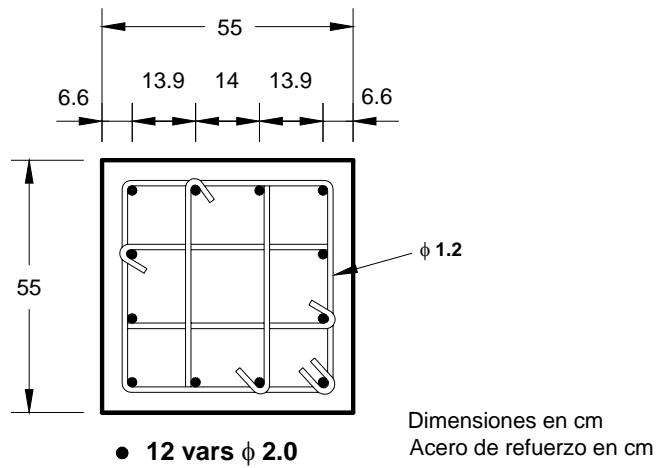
Configuración del armado de la columna UT5 (Tanaka y Park, 1990)
